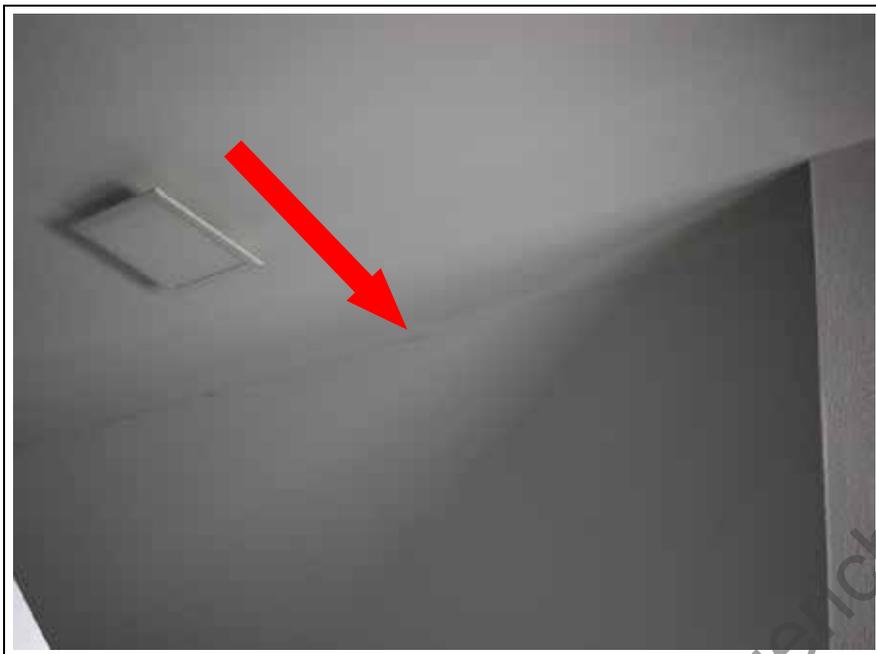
DG, Wohnung Nr. 7, Gipskartondecke mit sich öffnenden Fugen
